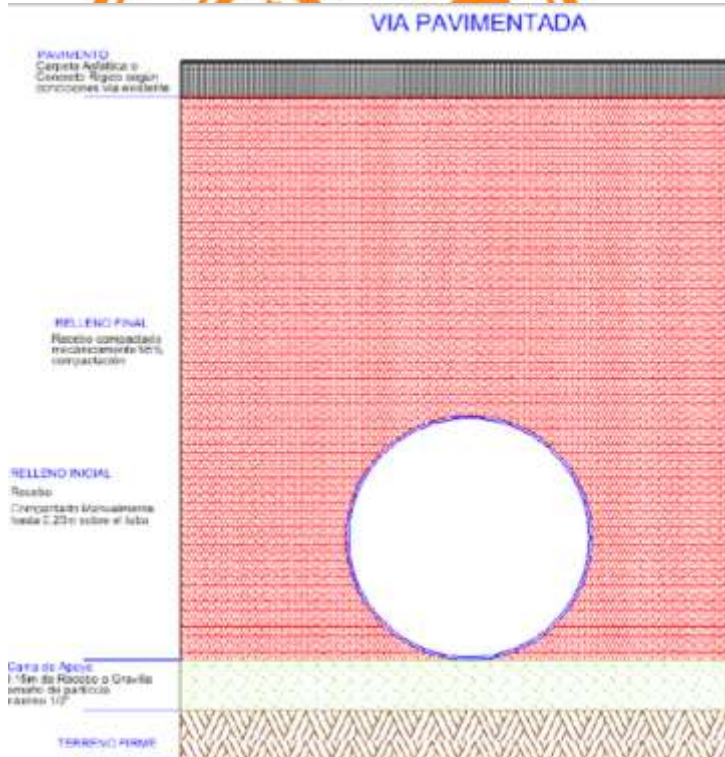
Instalación De Redes De Alcantarillado En Vía Pavimentada
